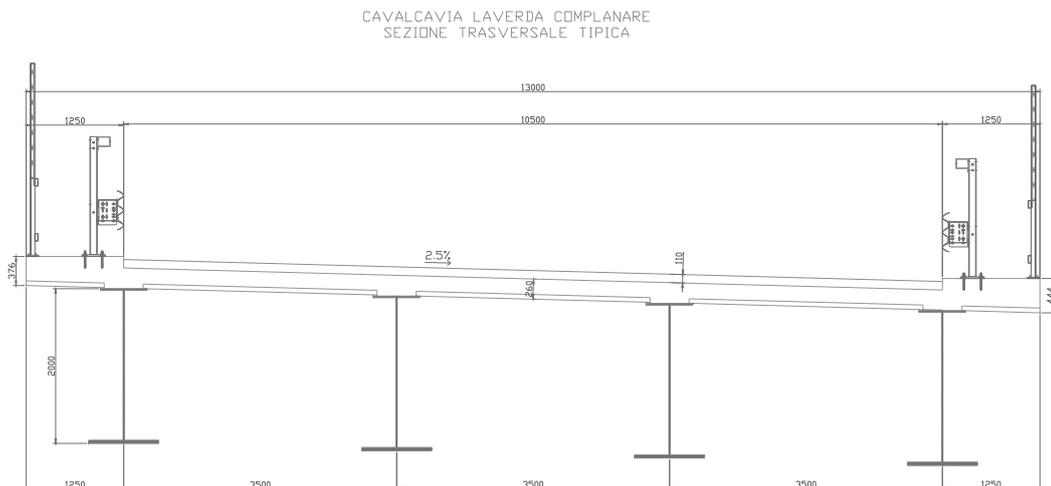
Sezione trasversale Ponte Torrente Laverda Complanare
